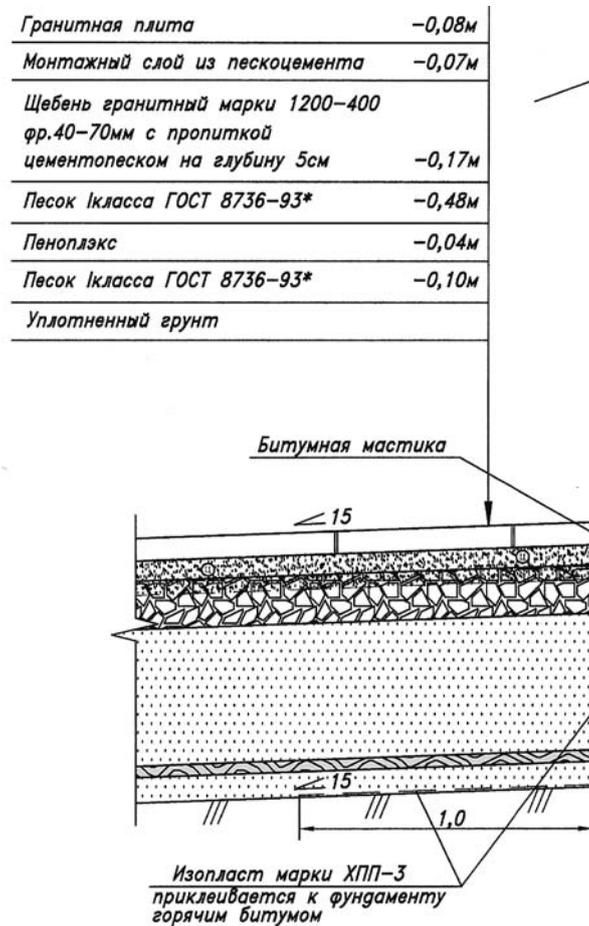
Гидроизоляция подземных частей зданий при устройстве дорожных покрытий из искусственных камней мощения.
